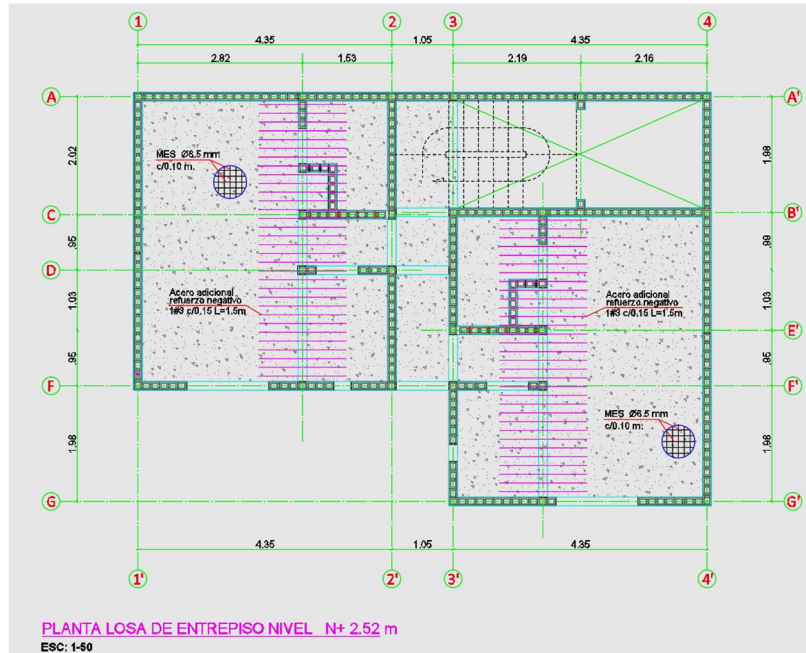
Planta losa de entrepiso – Aparta-estudios la 78
